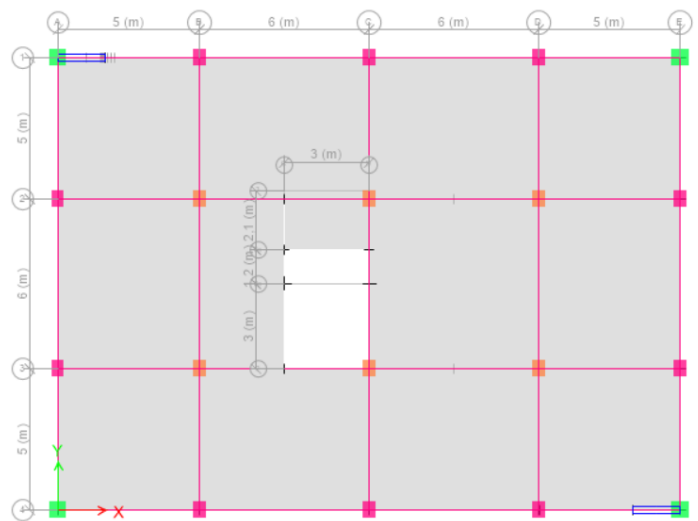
Vista en planta ubicación de los muros en estructura de hormigón.
